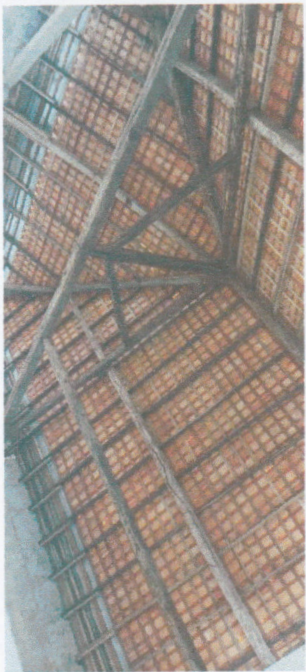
VISTA INTERNA DA EDIFICAÇÃO.
